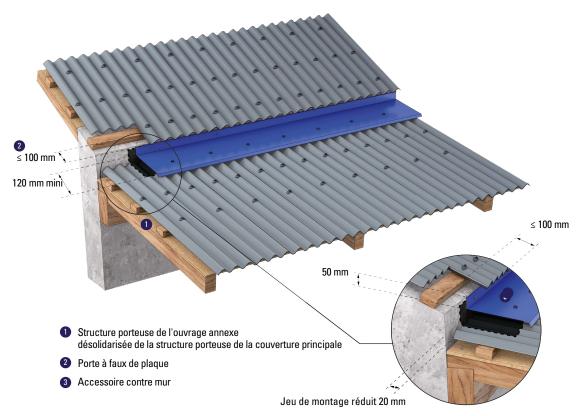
Traitement avec ressaut de la jonction entre toiture principale et auvent
